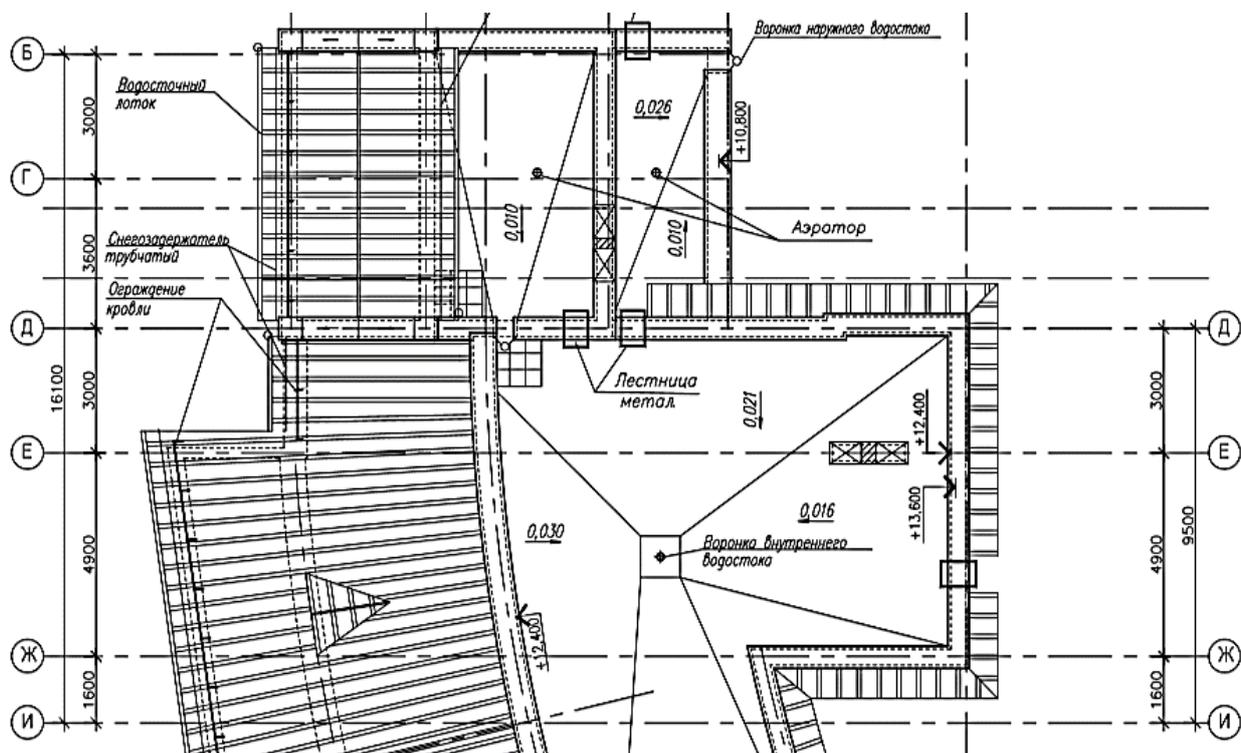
Фрагмент плана для плоской и скатной кровли
